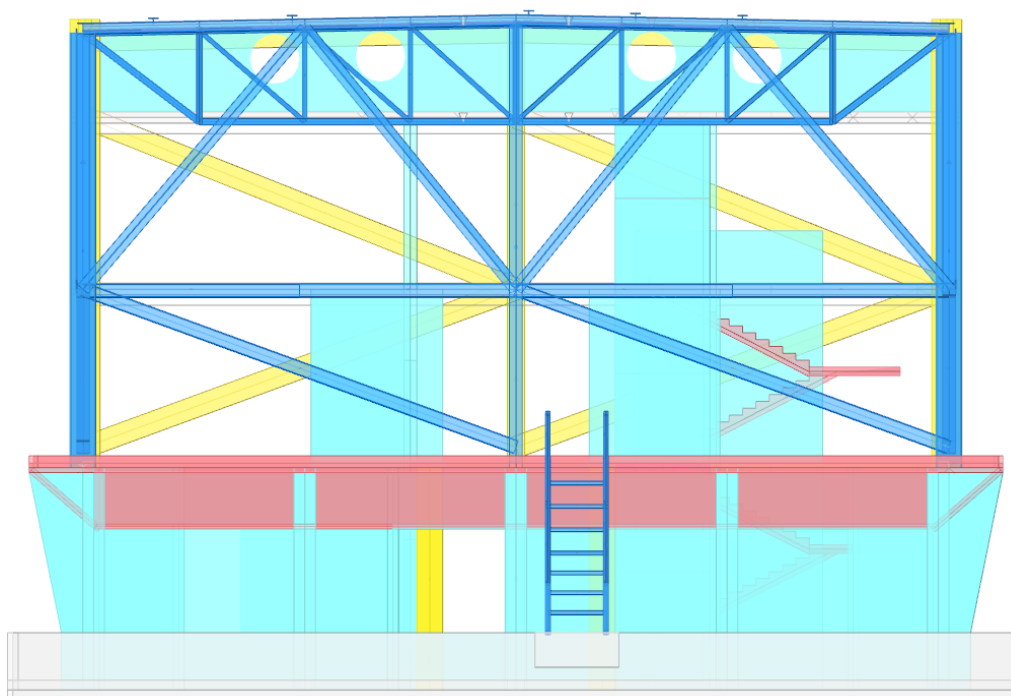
Vista 3D del Modello Strutturale FEM – Corpo A – Vista Prospettica Trasversale – Stato di Progetto
